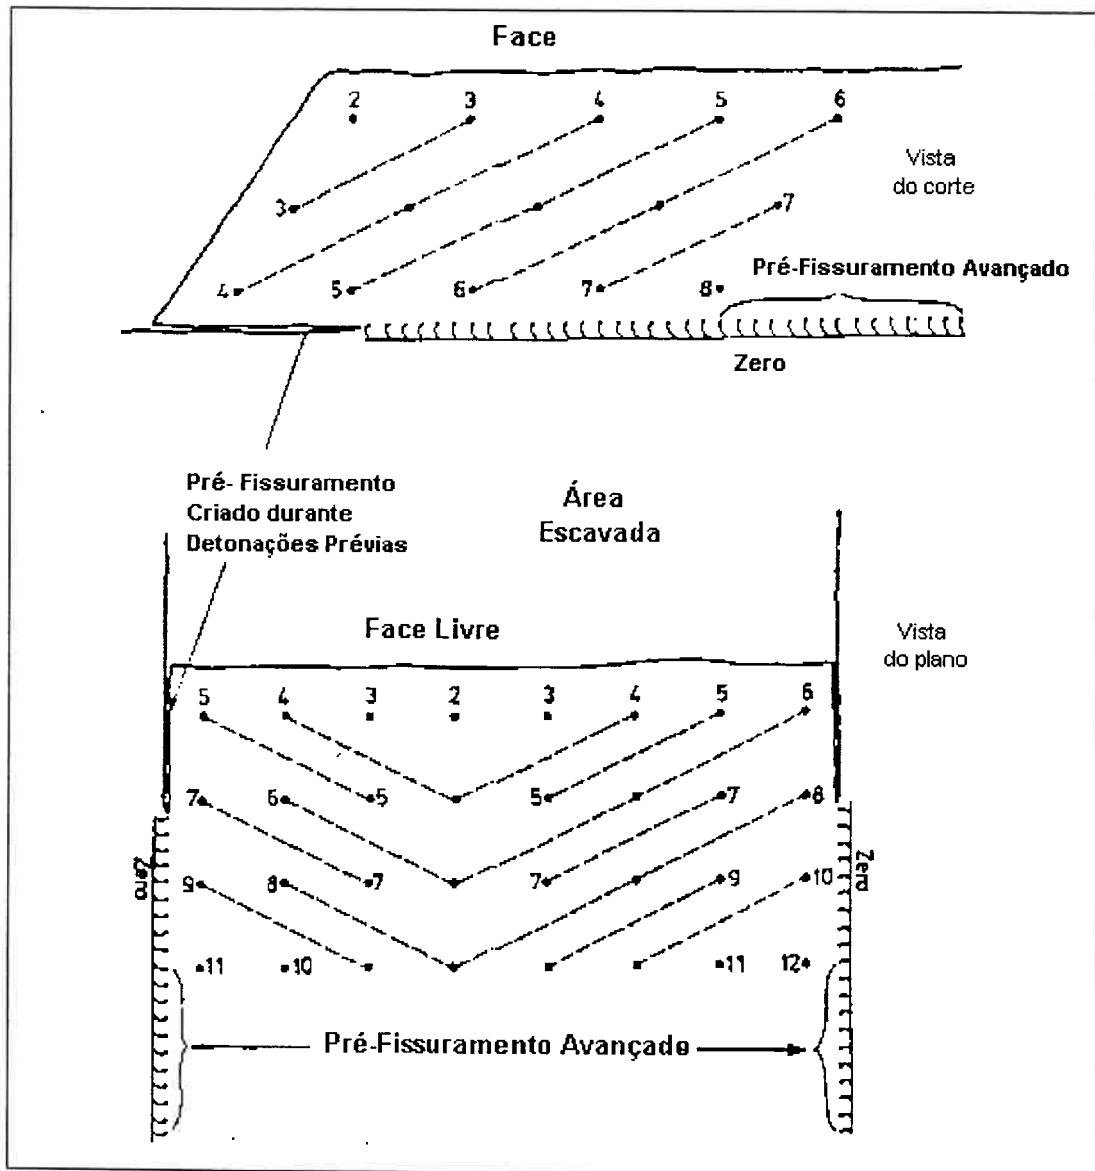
Desenho esquemático (em corte e planta) de linhas de furos de pré-fissuramento detonadas antes do desmonte. Cada número corresponde a uma seqüência (tempo) de detonação (GOLDER ASSOCIATES, s.d.)
